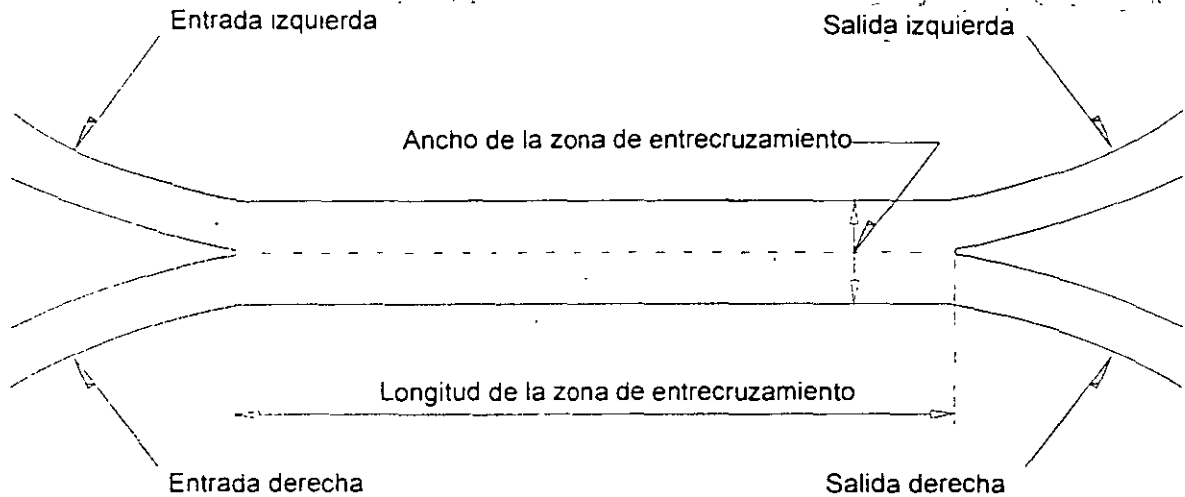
ZONA DE ENTRECruzAMIENTO
